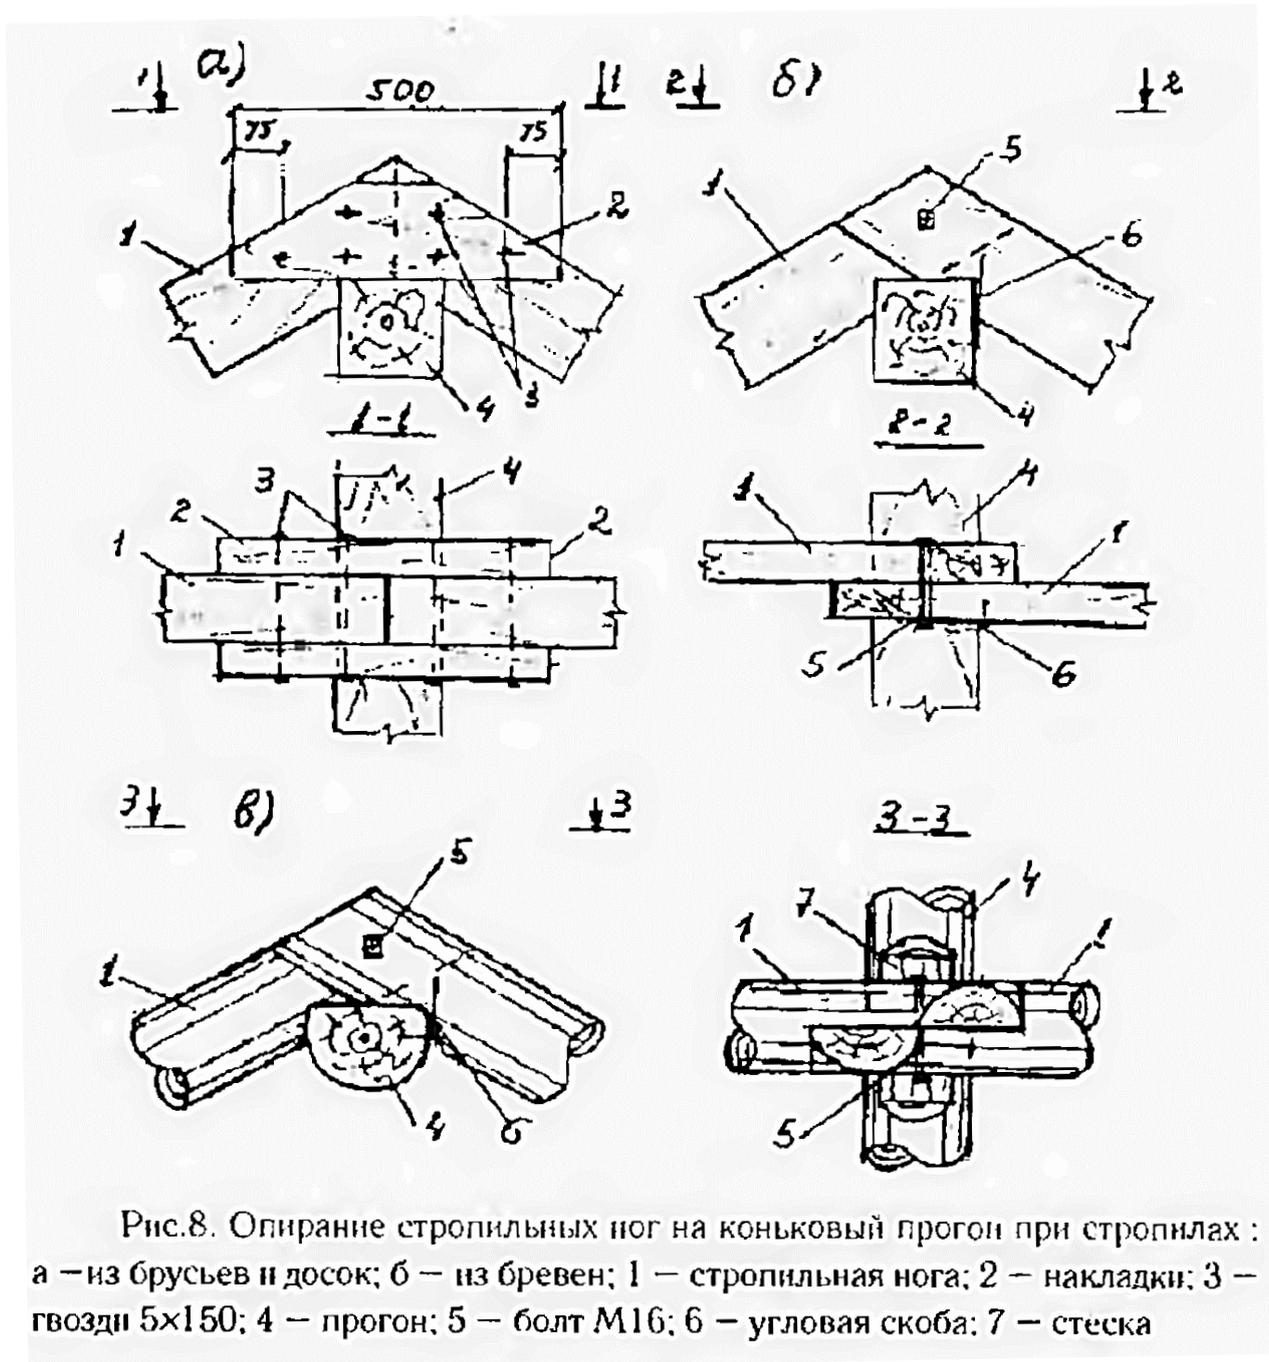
Опираие стропильных ног на коньковый прогон при стропилах :
